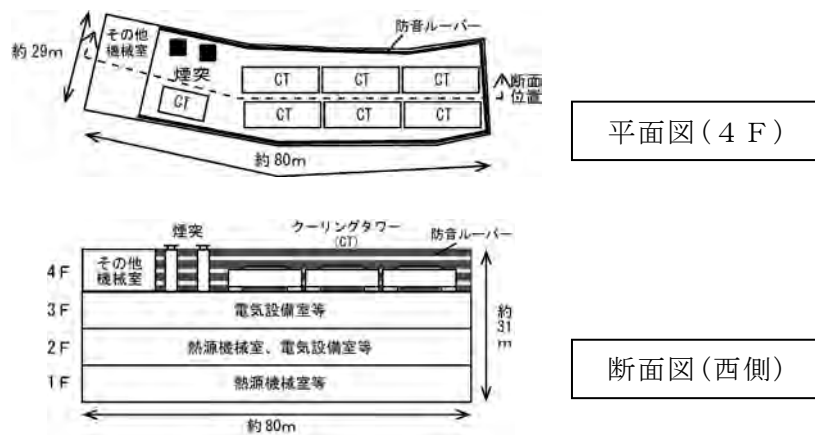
(2) エネルギー施設 B の平面図及び断面図
